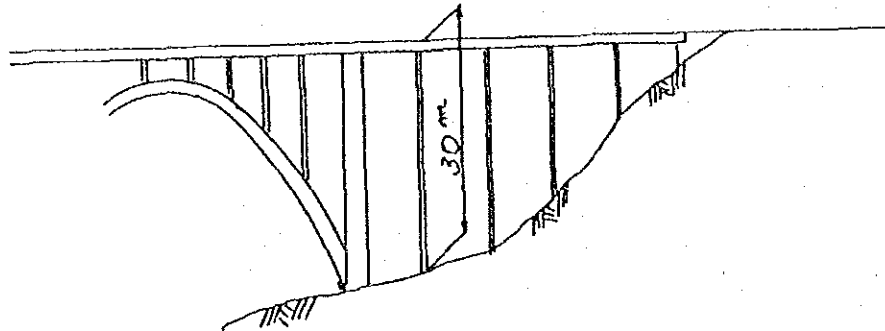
CEPAS TIPO COLUMNA DE Puentes EN ARCO
